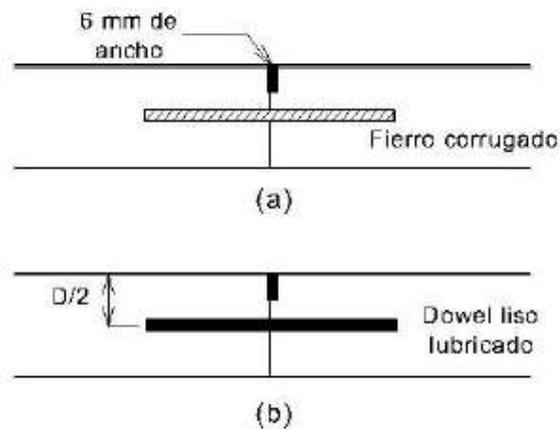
Juntas Transversales de construcción con diferentes tipos de dispositivos de transferencia de carga
